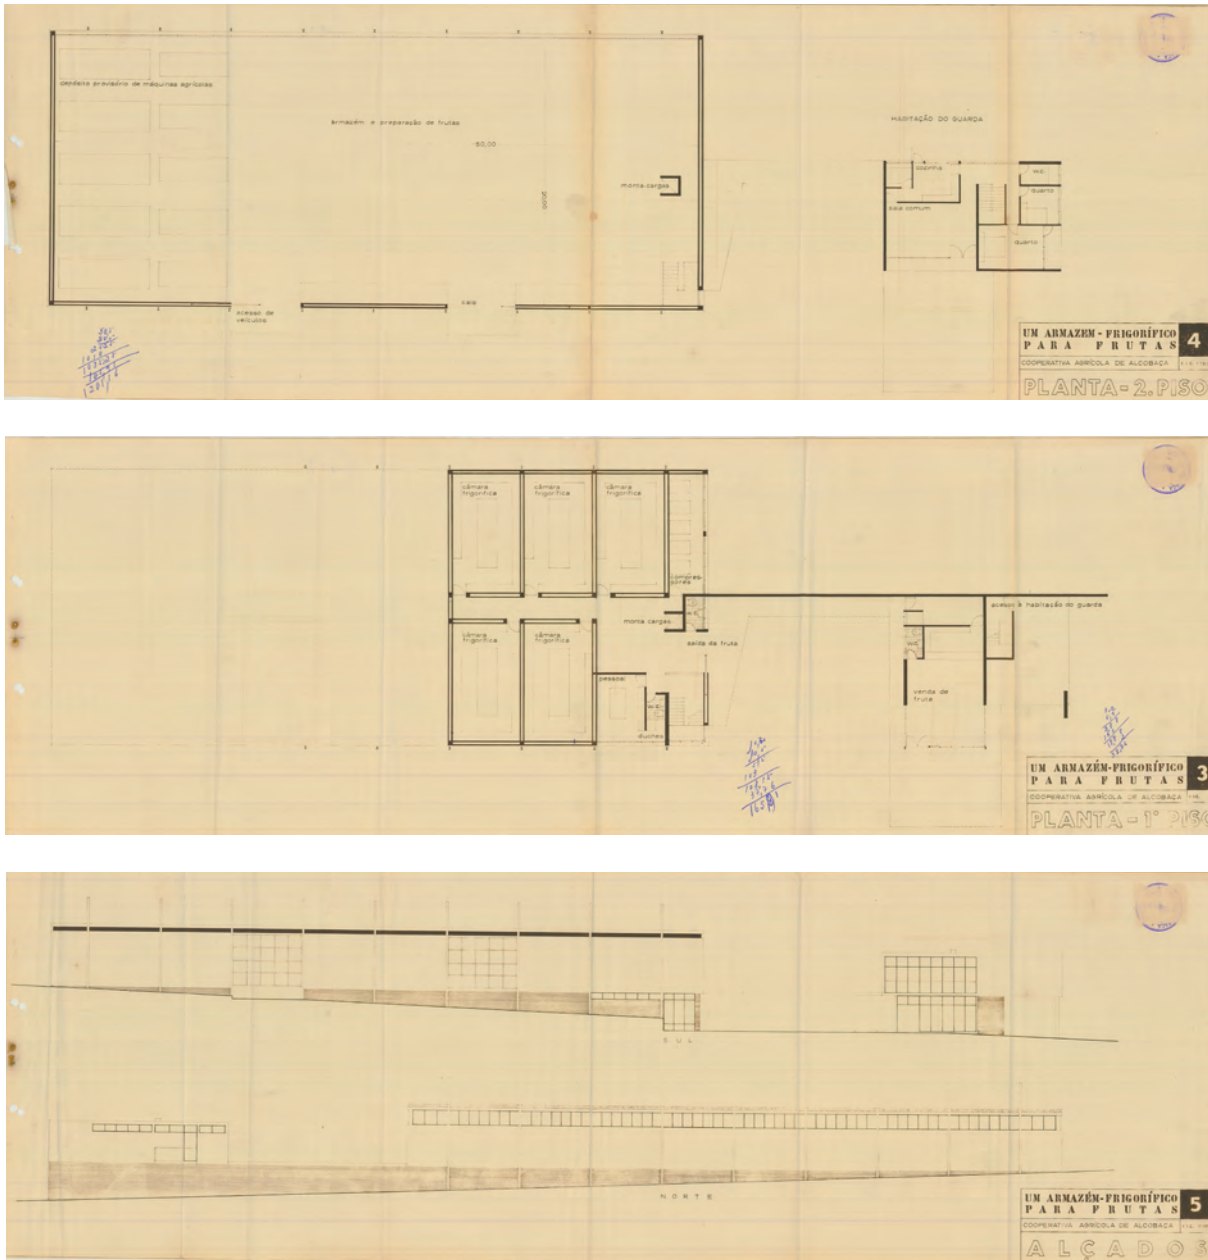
Processo de Obras nº 1157/58 – Planta 1º Piso, Planta 2º Piso e Alçados.
